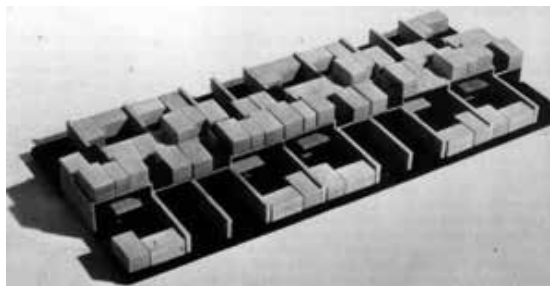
Casas expansíveis de 1963, Van Broek and Bakema_ Maqueta (Till, Wigglesworth e Schneider)
